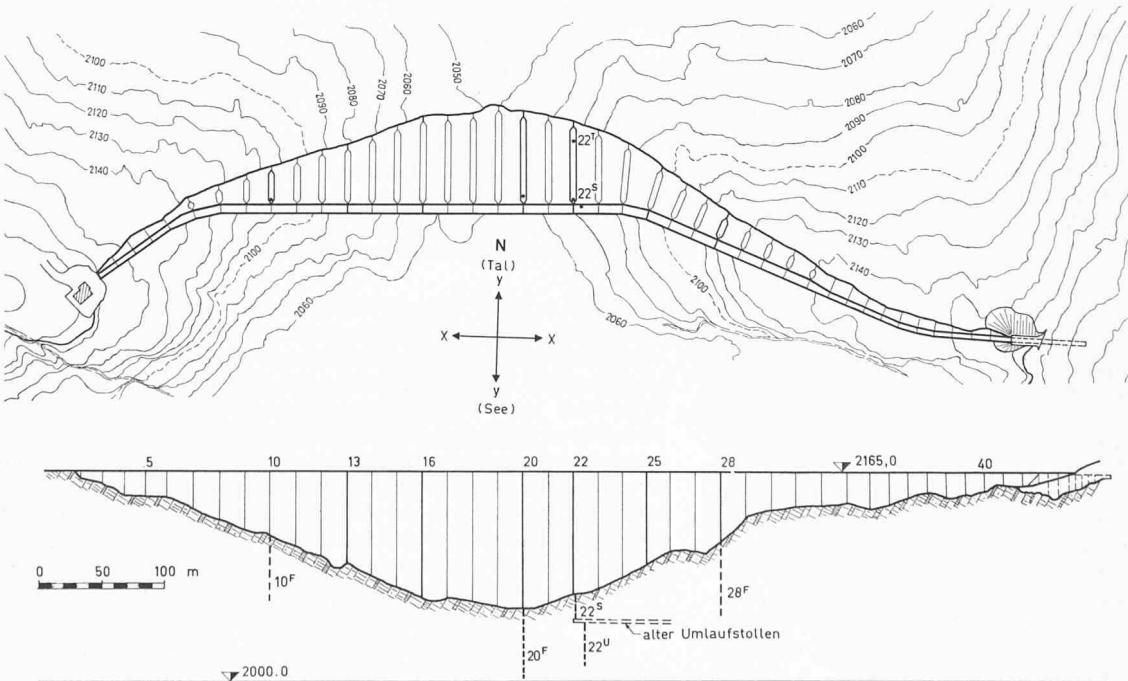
Ansicht und Grundriss der Staumauer Albigna, Massstab 1:6000
